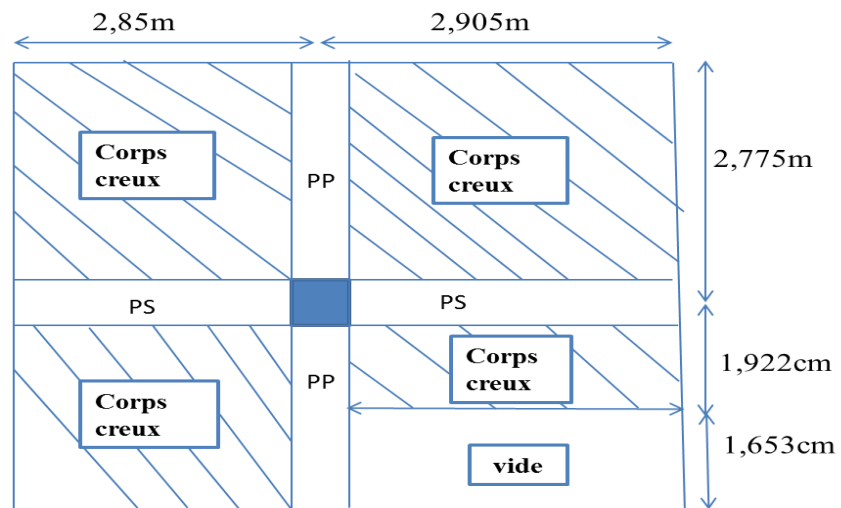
la surface supporte par le poteau central (niveau terrasse).
